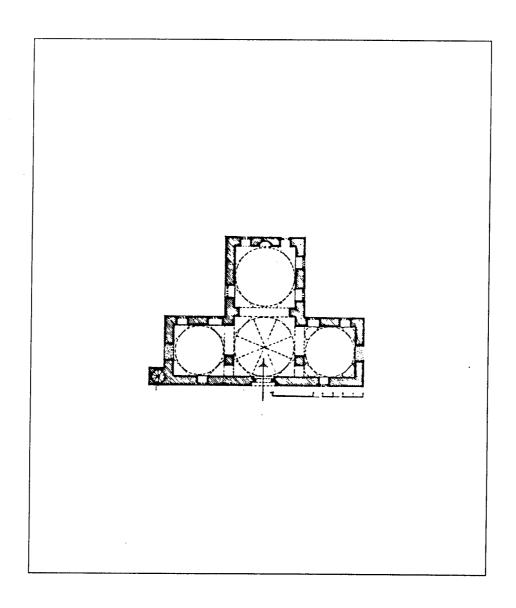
مسقط أفقي لمسجد غازي ميخال في أدرنة (عن : اصلان ابا)
